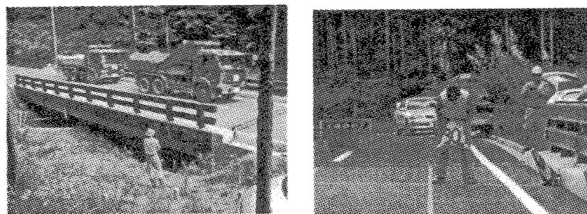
試験車両走行試験 写真-8 砂袋落下衝撃試験
